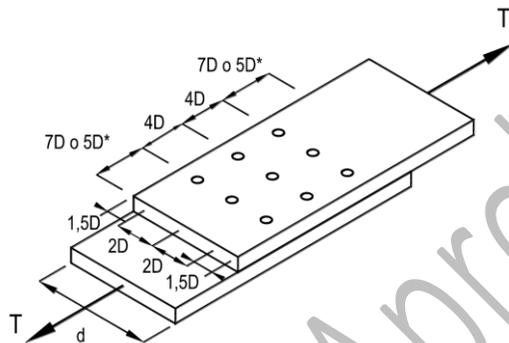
Espaciamiento entre pernos de uniones con cargas paralelas a la fibra
